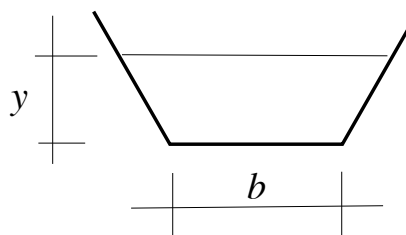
Sezione trapezia con sponde inclinate di 45° gradi.
